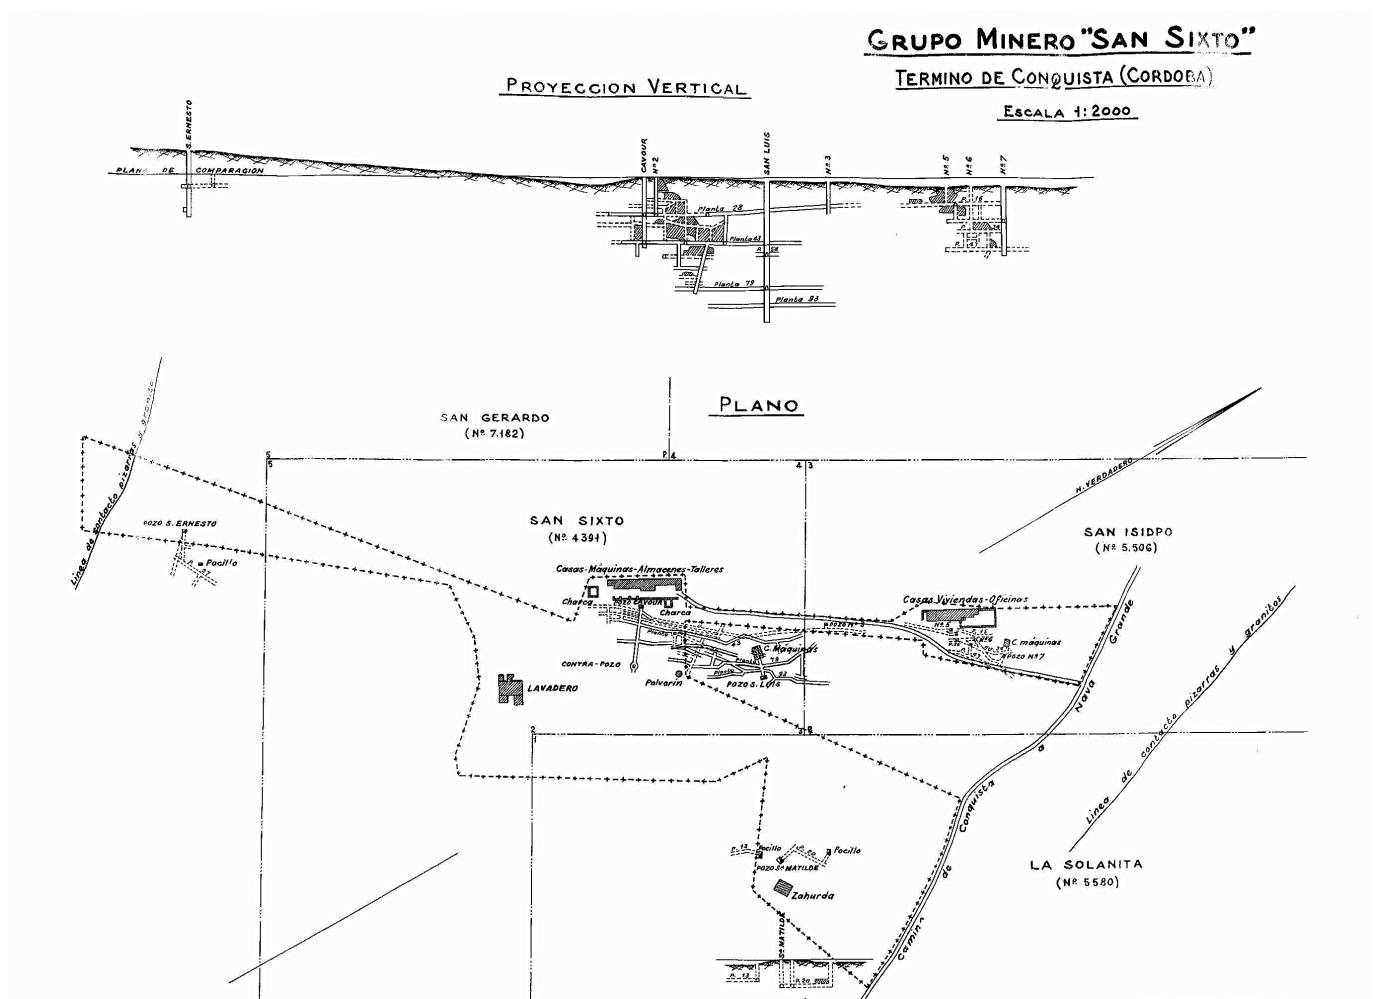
Proyección en planta y alzado de la mina "San Sixto", incluyendo la concesión "San Isidro", donde se sitúa el "Pozo Número 7".
